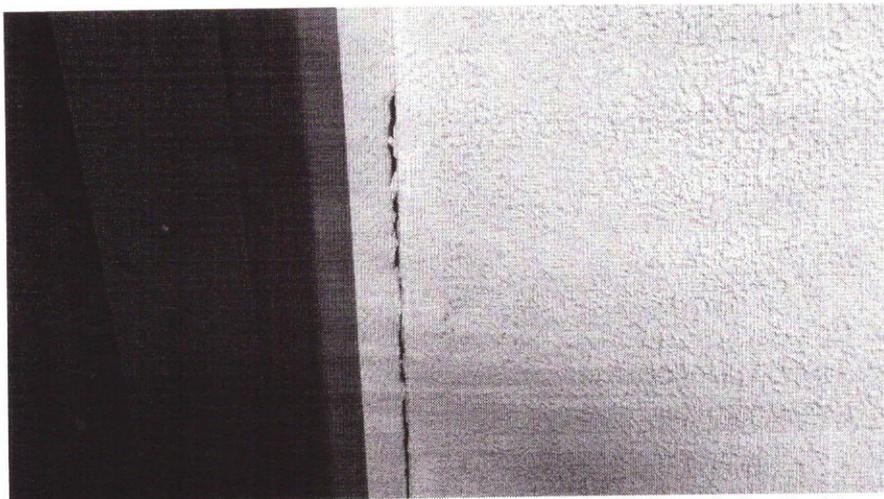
Imagem com vista da área interna do prédio do bloco 11 onde podem ser observadas fissuras em decorrência da movimentação na fundação.
